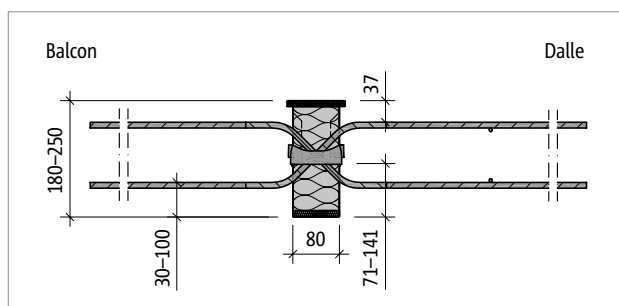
Schöck Isokorb® T type Q-E-VV5 : coupe du produit
